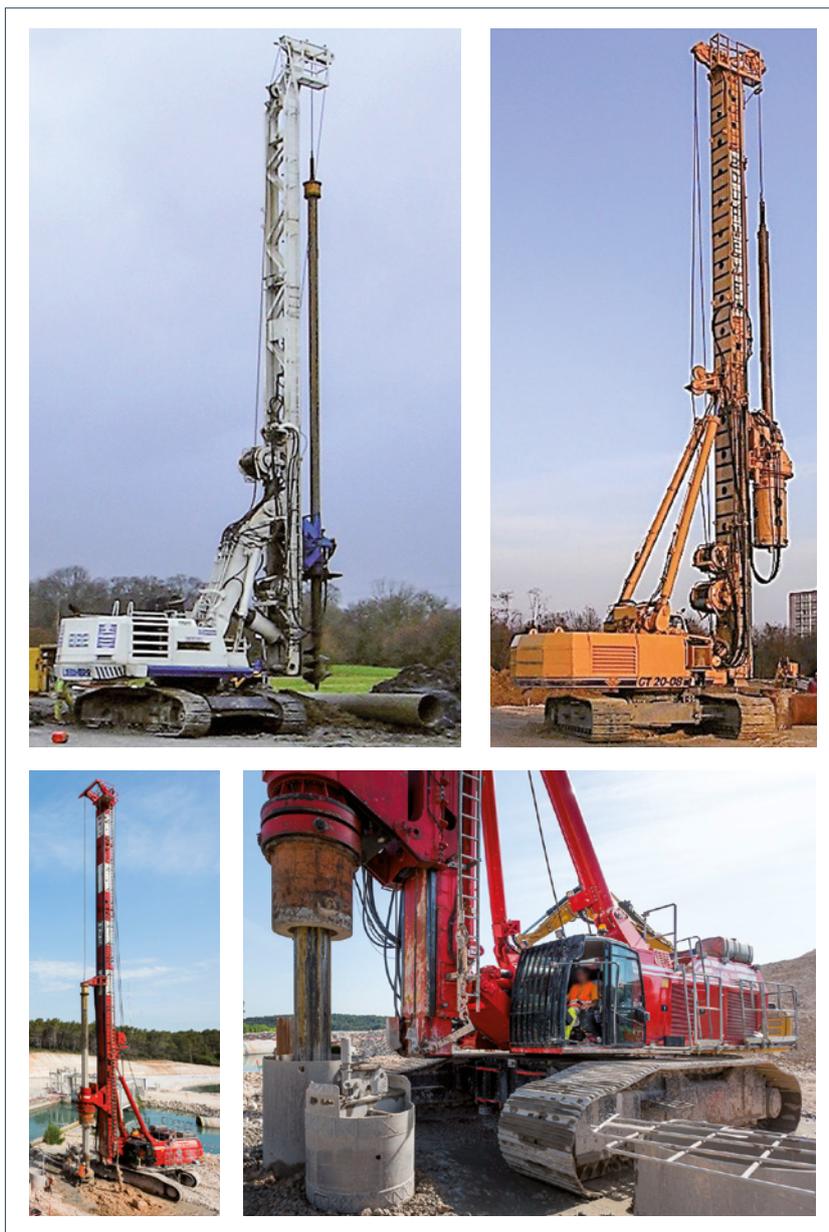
Grue ou pelle à câbles équipée d'un kelly
